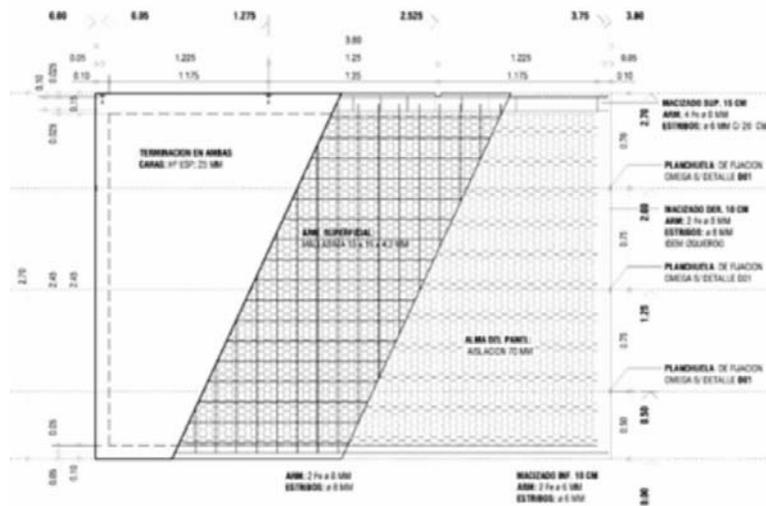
Esquema de armado de panel PS120 utilizado en la obra “140 Viviendas en B° Jesuitas”
